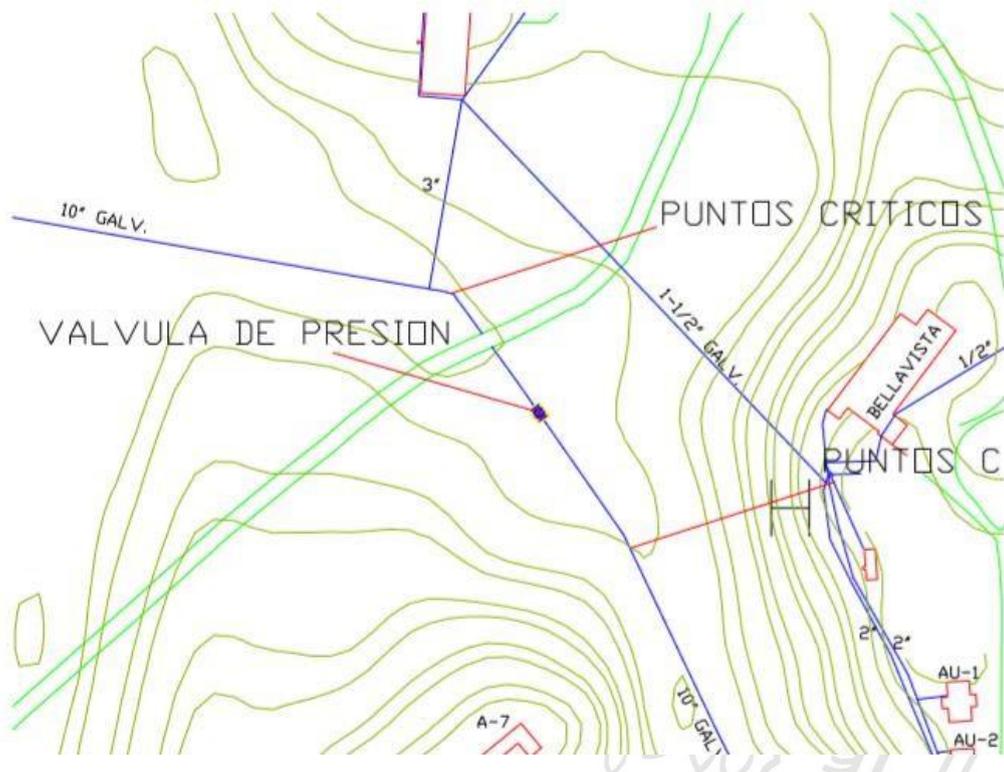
Plano en AutoCAD de la instalación de la válvula Ventosa.
